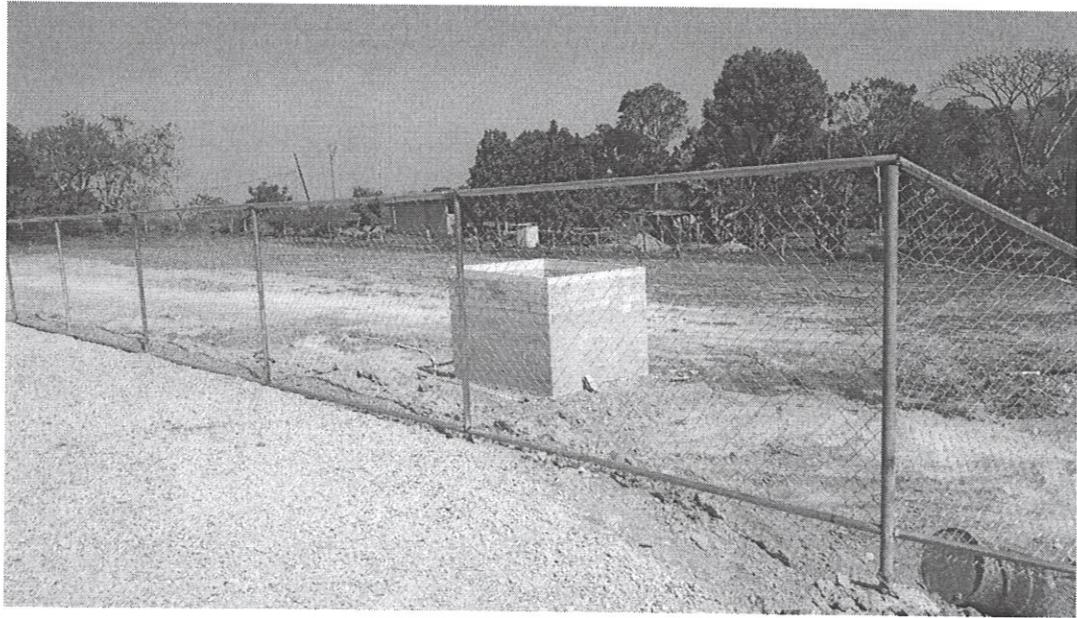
Vista de la construcción de la piscina, se observó la construcción de una nueva estructura a un costado de la piscina (que será techada). Esta estructura no está contemplada en el plano del proyecto.
